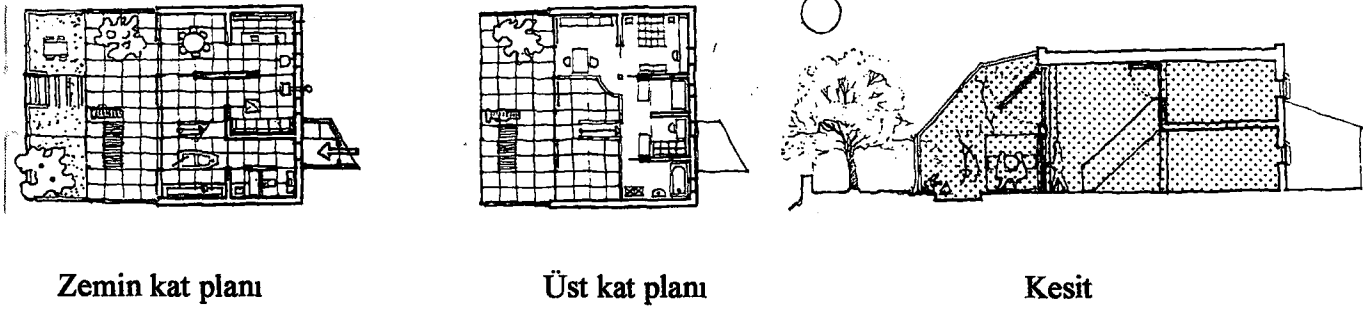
Berlin'deki toplu konutun vaziyet planı ve bir konutun kesiti
